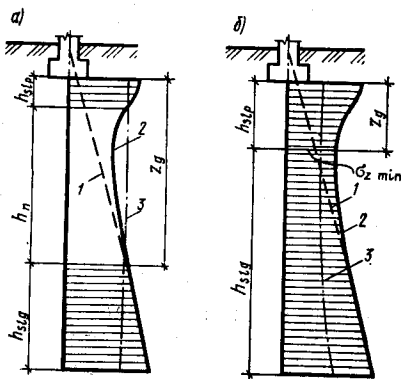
Некоторые схемы к расчету просадок основания:
